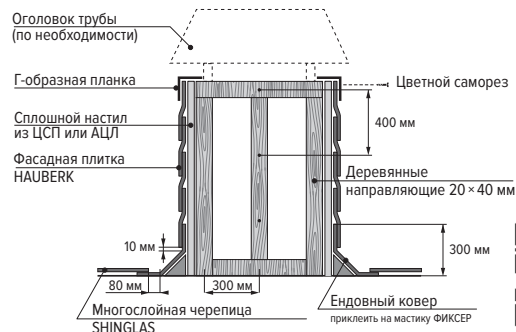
Монтаж фасадной плитки на вентиляционную трубу
